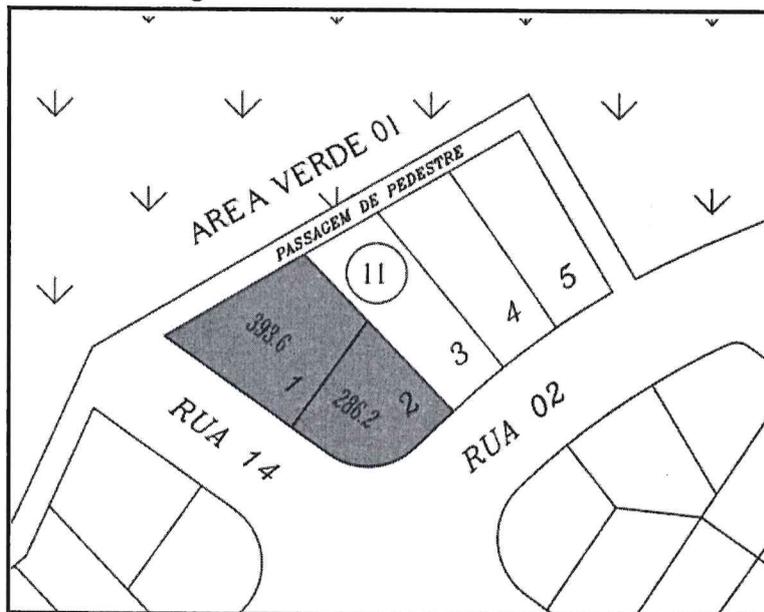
Planta dos lotes 1 e 2 da quadra 11 do Bairro Santa Rosa.
